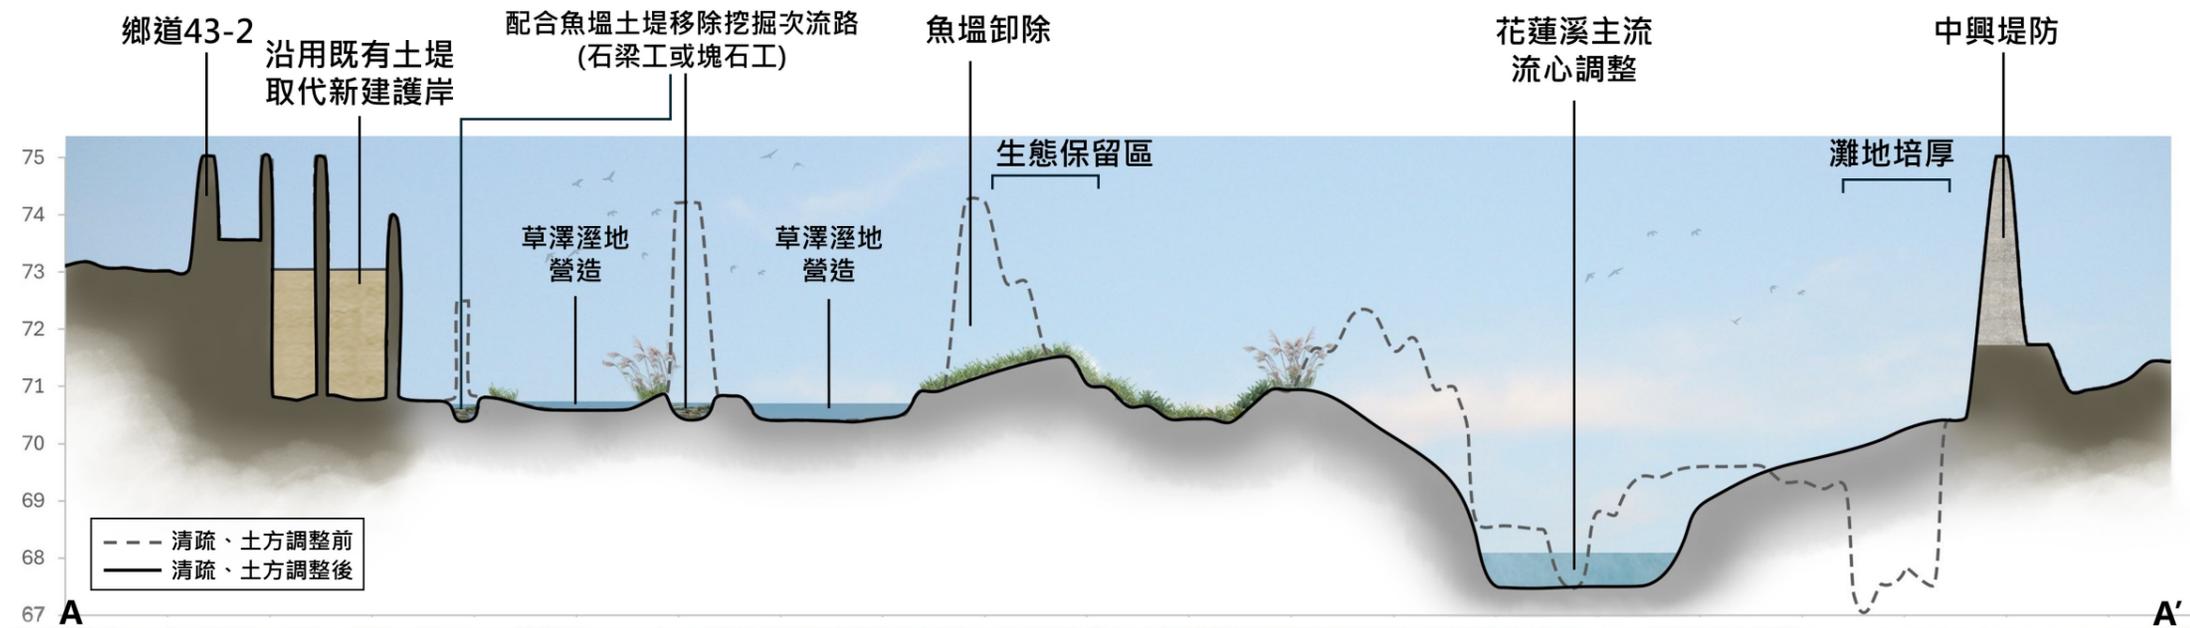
計畫區改善調適方案平面及剖面圖示意
